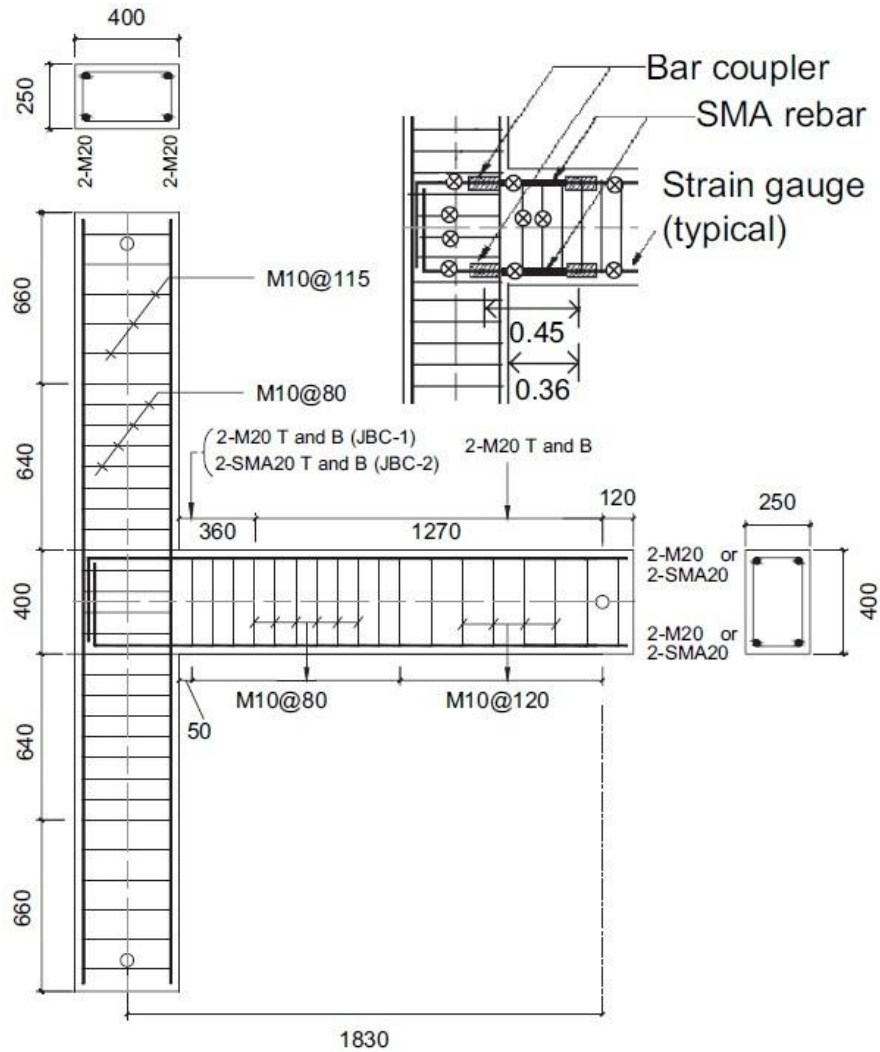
Pormenorização do reforço da ligação viga-pilar JBC-1 e JBC-2 (dimensões em mm) [92]
